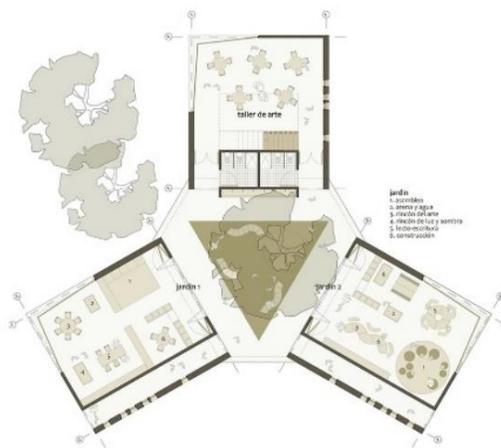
Configuración espacial en forma de pétalo. Planimetría. Fuente: www.archdaily.com.co
